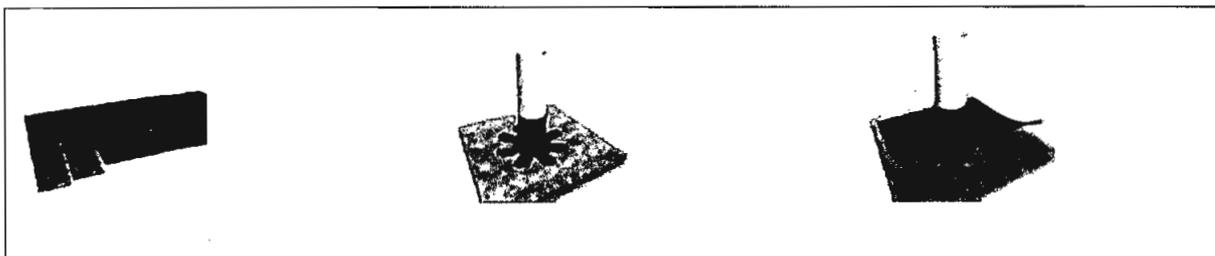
Imagens esquemáticas de aplicação de manta asfáltica tubulação que perfura a laje.
